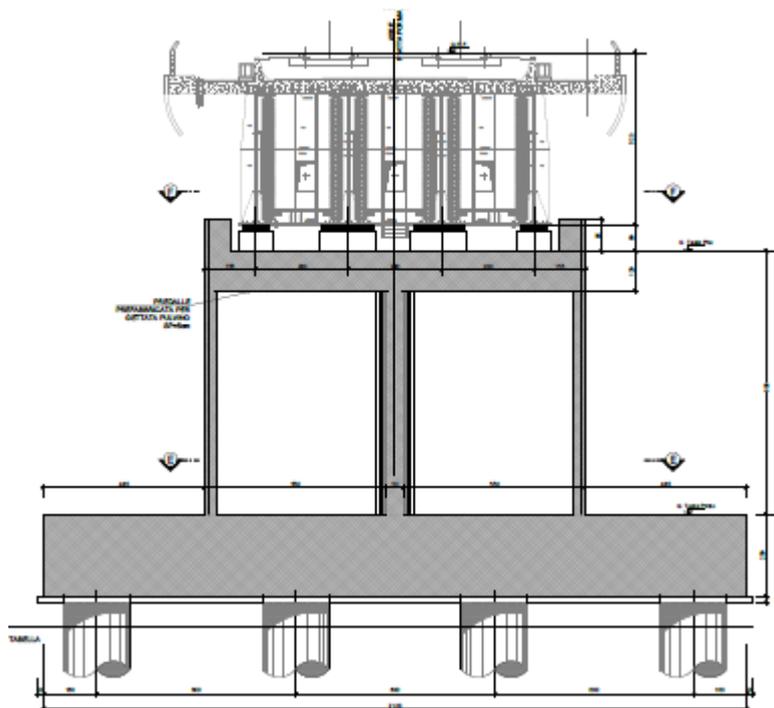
Sezione in direzione trasversale rispetto all'asse del viadotto
